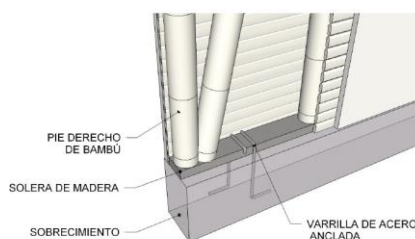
Fundação de paredes tipo 1 - (Ministerio de Vivienda, C.y.S.d.P., 2012)
